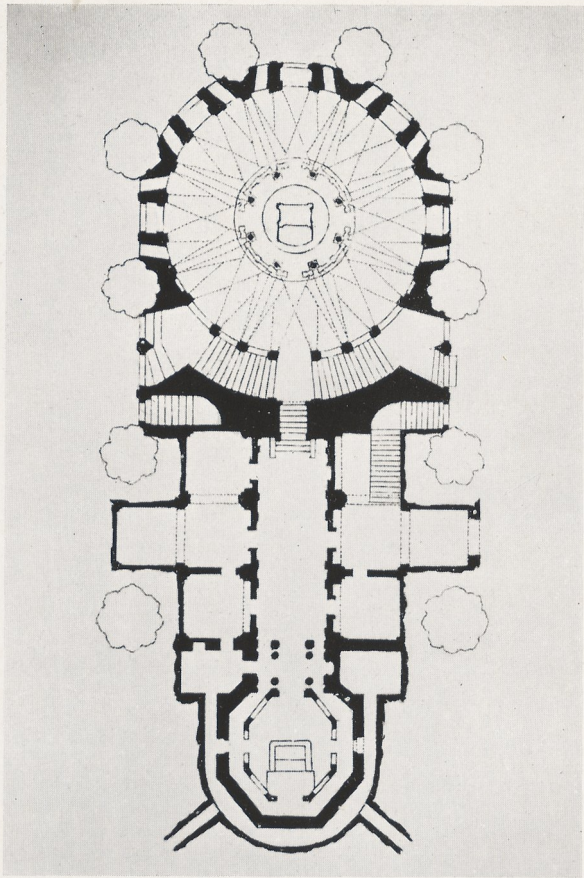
Mailand, Domkrypta, Grundriß (nach Boito)
